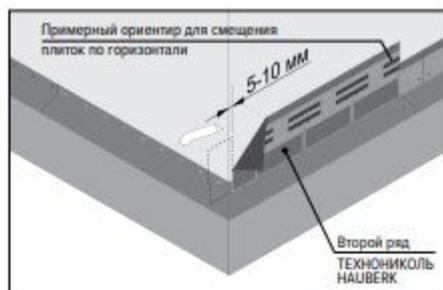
Монтаж первого и последующих рядов фасадной плитки
